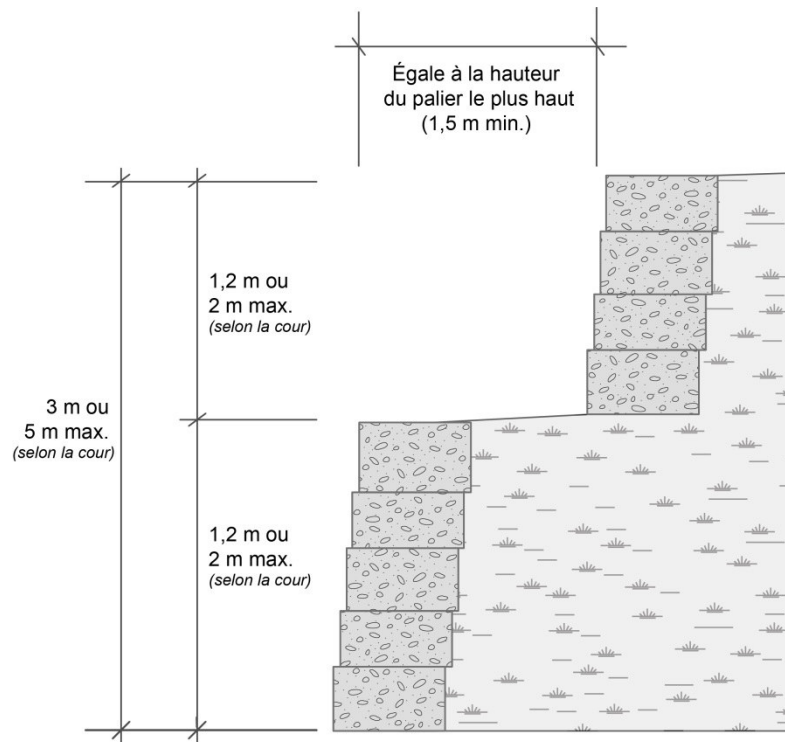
Hauteur maximale d'un mur de soutènement en paliers successifs
